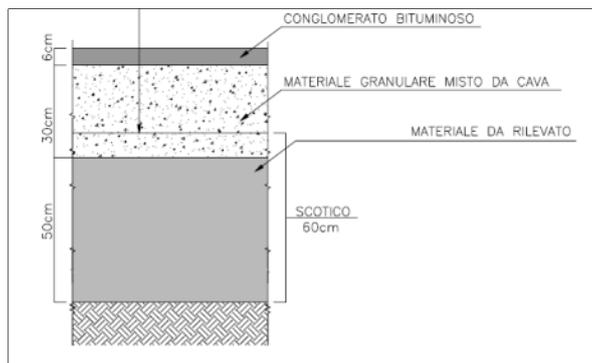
Particolare pavimentazione campo base e cantieri operativi
